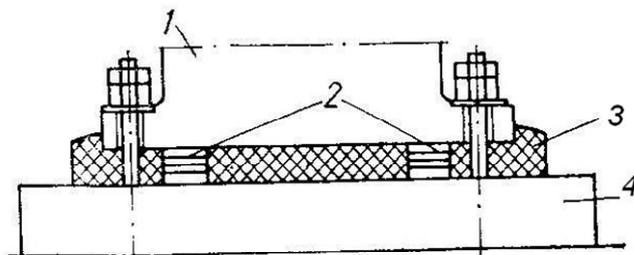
Схема установки оборудования на фундамент с опиранием на пакеты подкладок:
